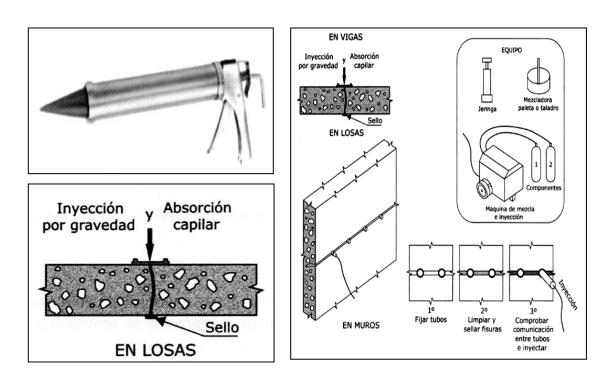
Esquema general de la aplicación de la lechada a una losa ó muro Fuente: Paulo Helene y Fernanda Pereira.
